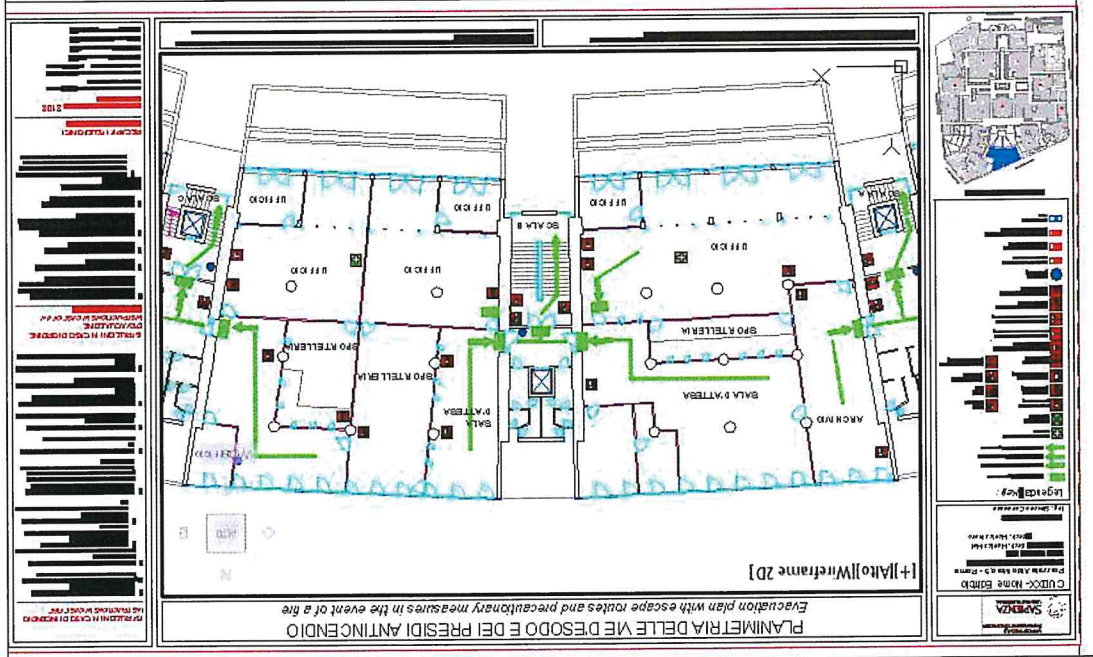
Esempio di Planimetria riportante le Vie di Fuga
